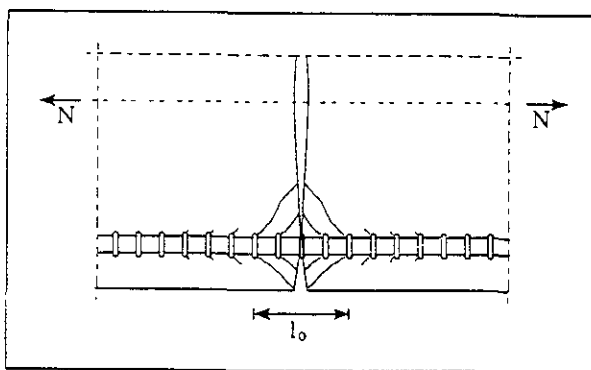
Grietas de tensión / deslizamiento por adherencia
